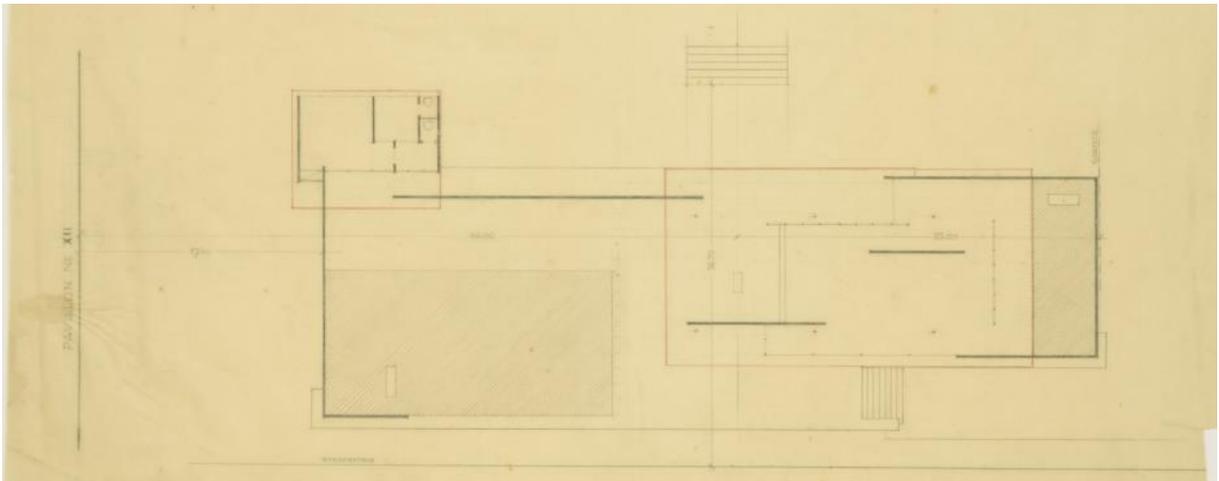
Planta baixa do Pavilhão da Alemanha | Barcelona 1929
